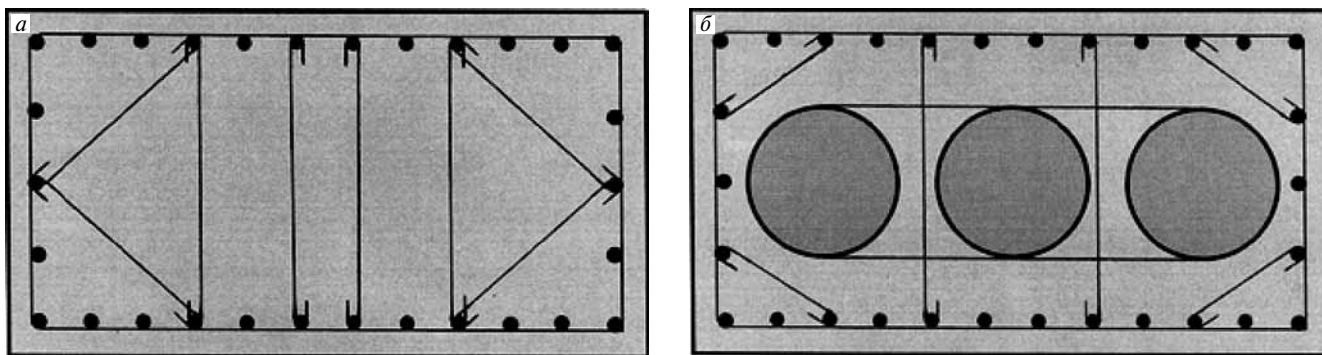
Поперечное сечение колонны: а – железобетонной (ЖБ) сечением 1,2×2,2 м ($A = 26400 \text{ см}^2$); б – трубжелезобетонной (ТЖБ) сечением 1,2×2,2 м с тремя трубобетонными элементами $\varnothing 53 \text{ см}$. Сетка по периметру колонны на расстоянии 4 см от наружных поверхностей в соответствии с требованиями по огнестойкости на этом и последующих рисунках условно не показана
